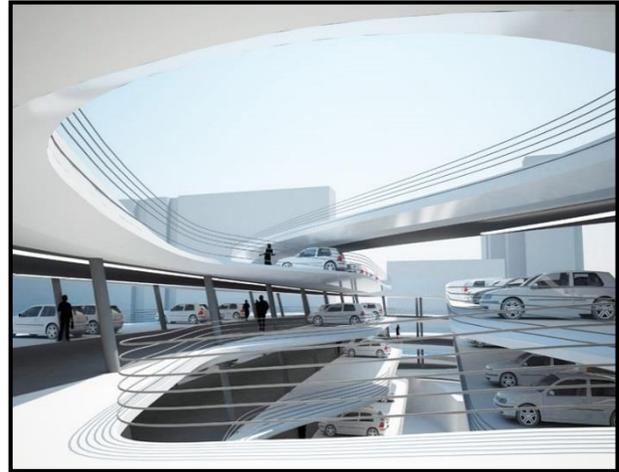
Vista Interior de las rampas de Estacionamiento
